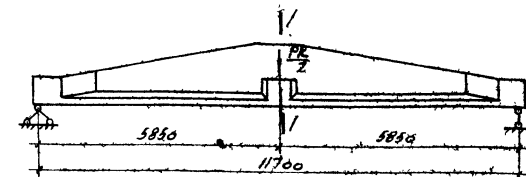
СХЕМА ИСПЫТАНИЯ БАЛОК
